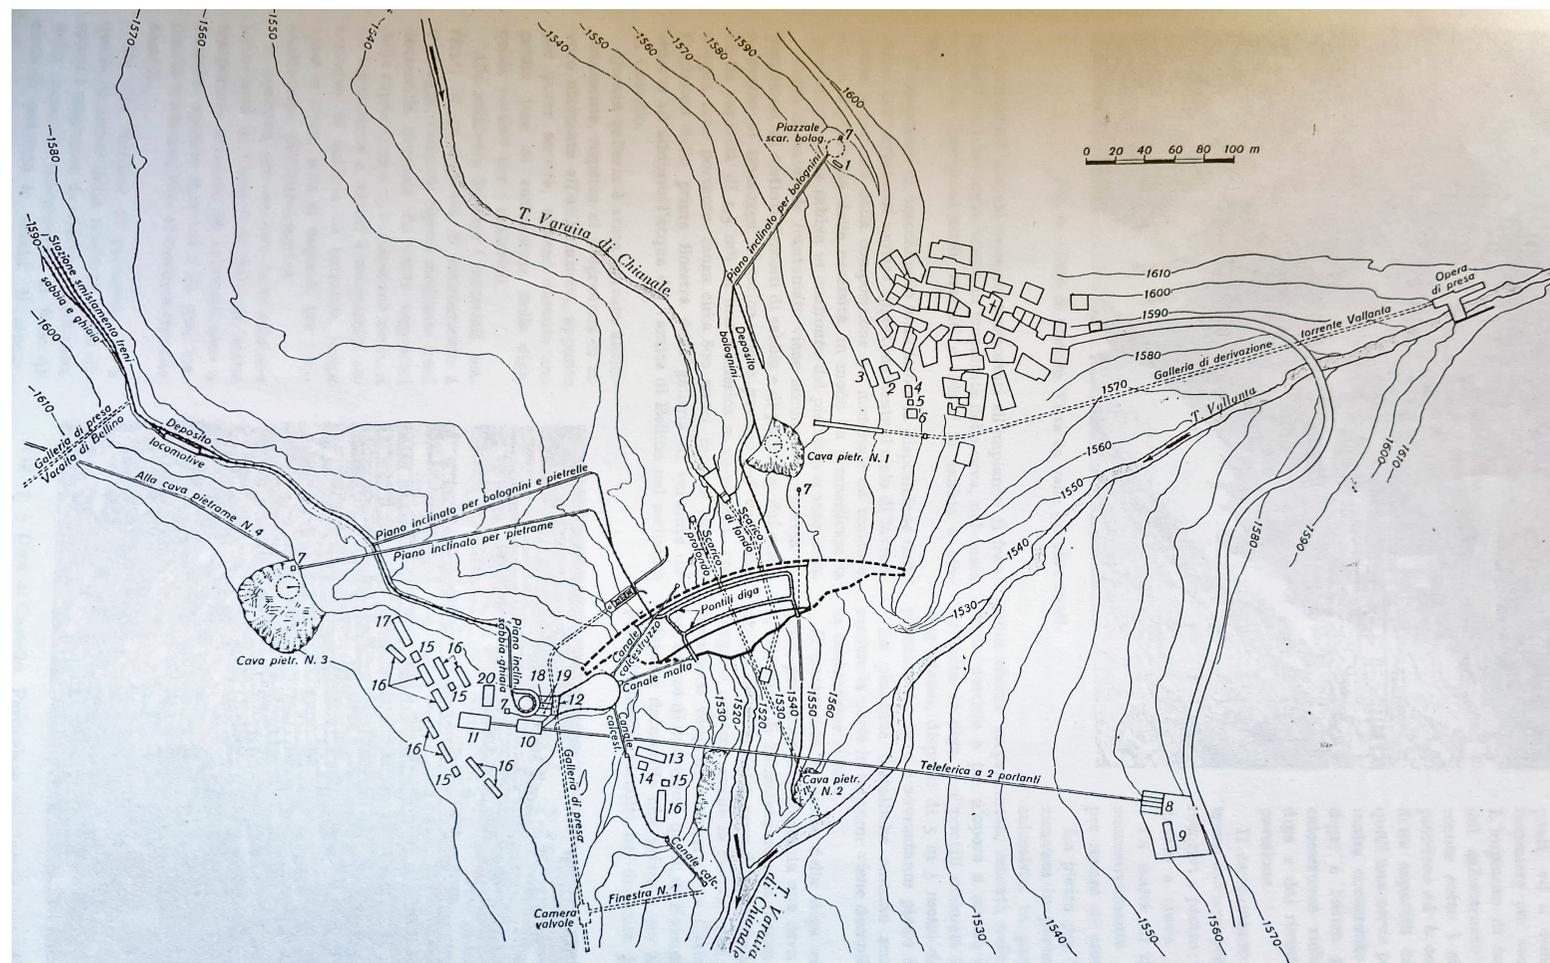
Diga di Castello. Planimetria generale del cantiere.
